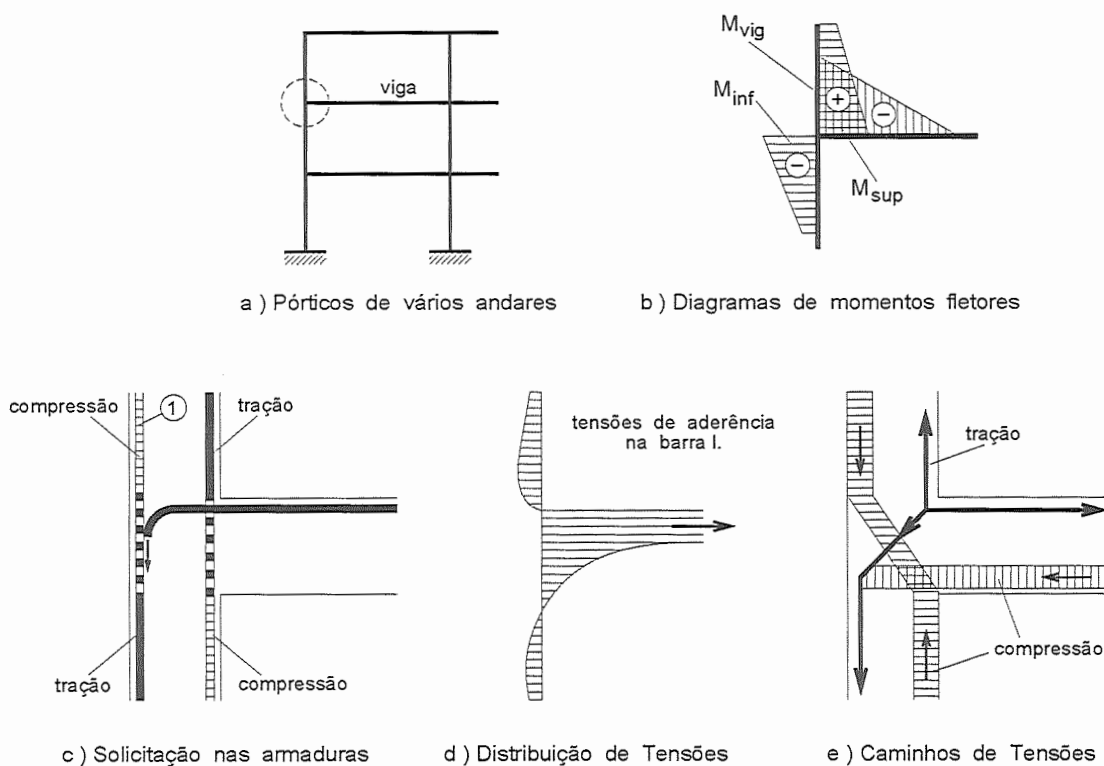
Viga engastada elasticamente em pilar de extremidade
